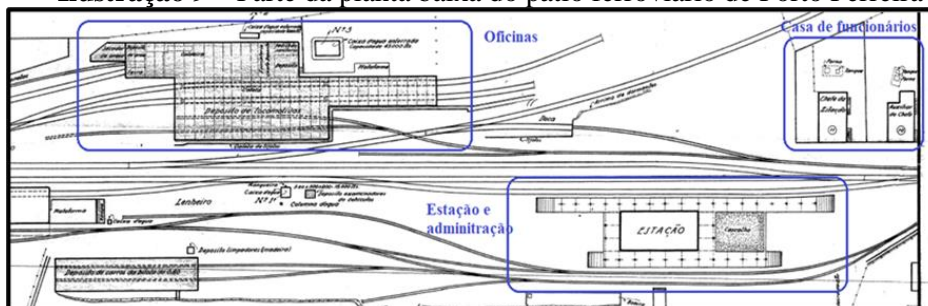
Parte da planta baixa do pátio ferroviário de Porto Ferreira
